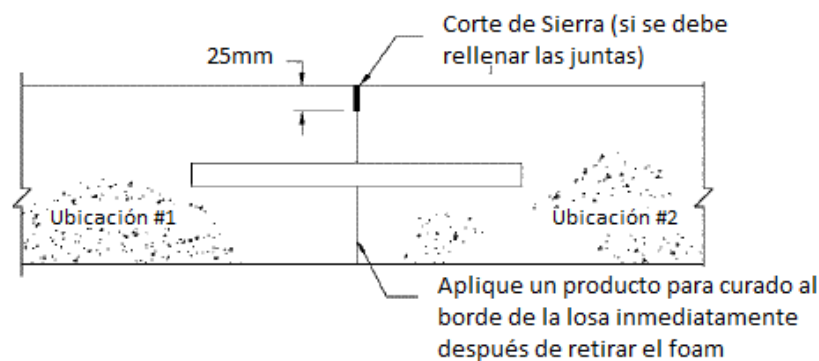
Junta en equipo de construcción fundido (ACI 360, 2016)
